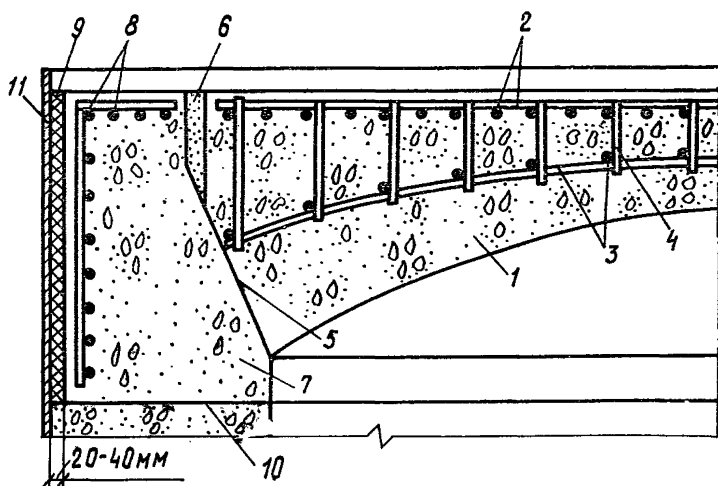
Конструкция железобетонного купола покрытия с плоской верхней поверхностью из жаростойкого бетона для круглого теплового агрегата
